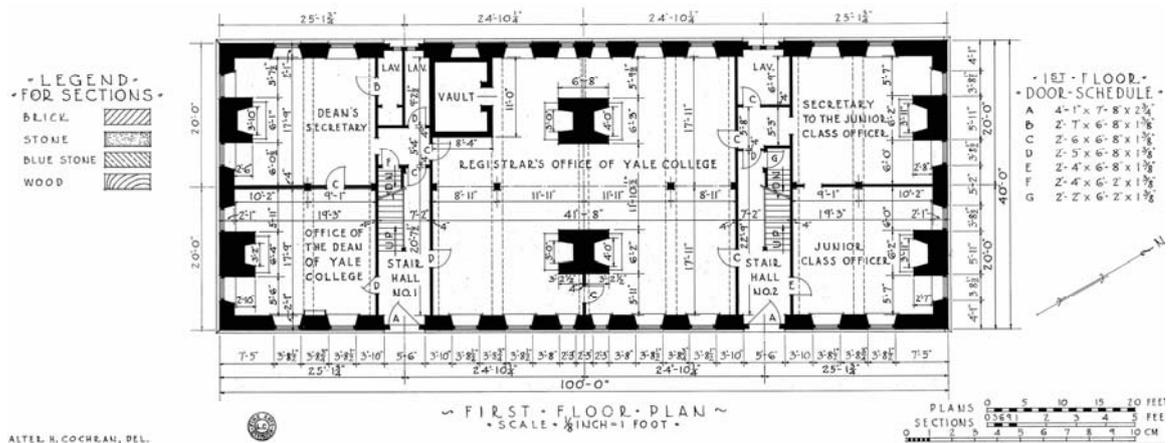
5: Connecticut Hall, erstes Geschoss nach Umbau
